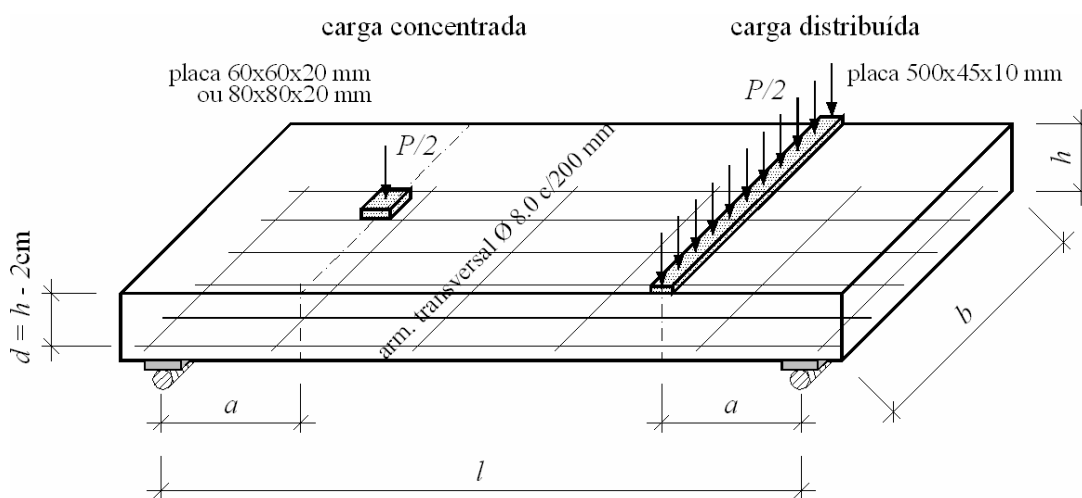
Detalhe das faixas de lajes ensaiadas por Leonhardt e Walther (1962)
